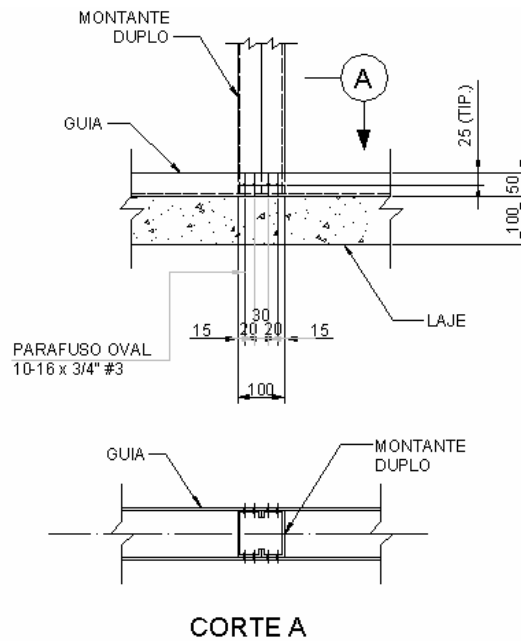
Detalhe construtivo da ligação Montante Duplo - Guia [3]
